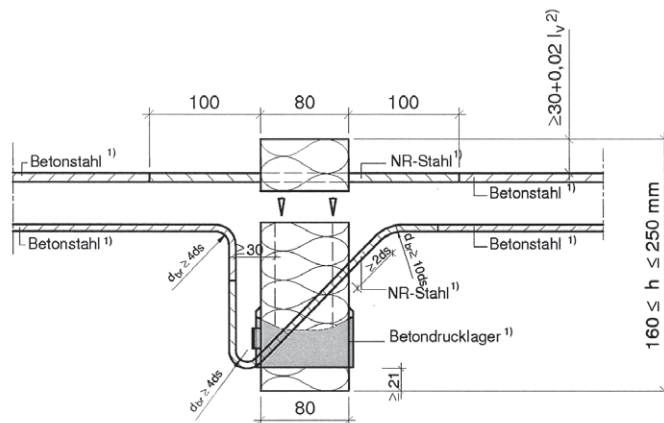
Beispiel Schöck Isokorb Typ RK-240 mit Druck- Querkraft Kombination und integrierter Aufhängebewehrung nach Abschn. 3.3.1, Z-15.7-240
